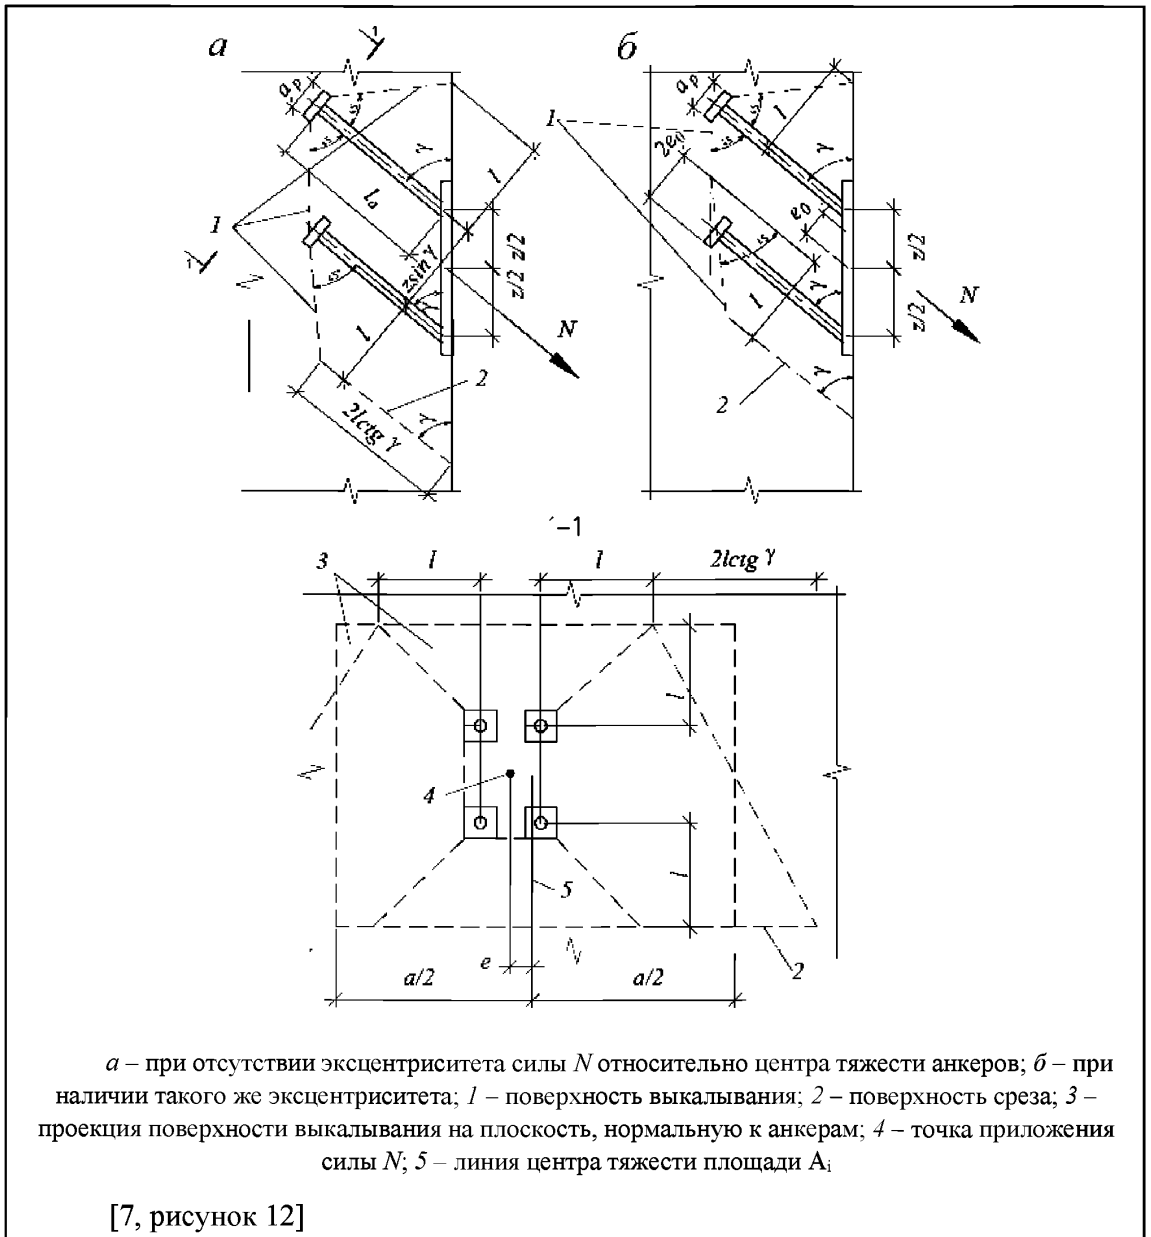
Схема выкалывания бетона наклонными анкерами при отсутствии прижатия к основанию
